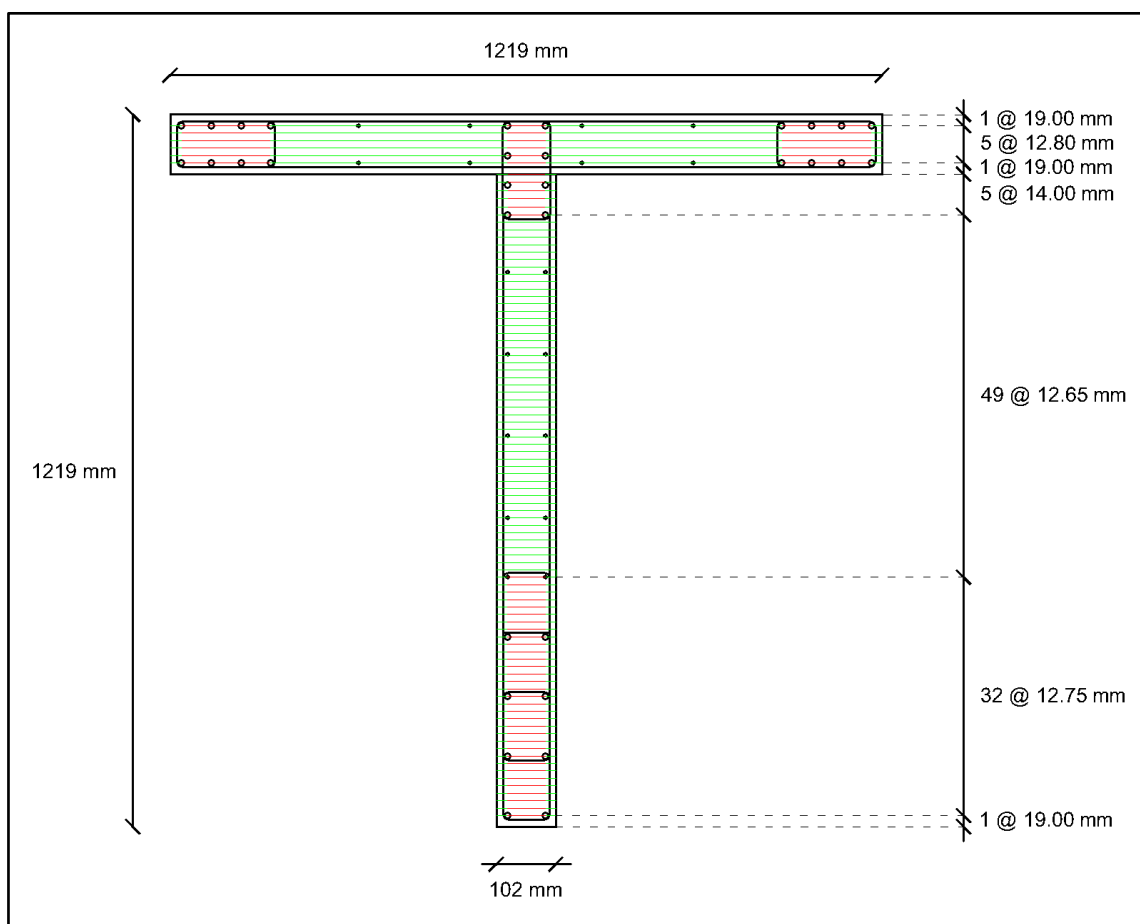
Discretización en fibras de la sección transversal del muro TW2.
